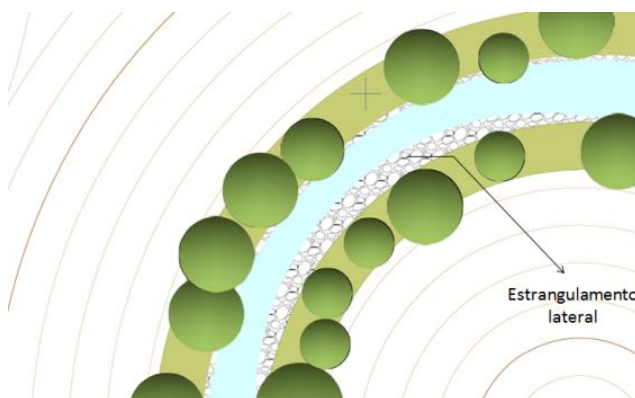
Planta da zona de um estrangulamento lateral no canal 1.
